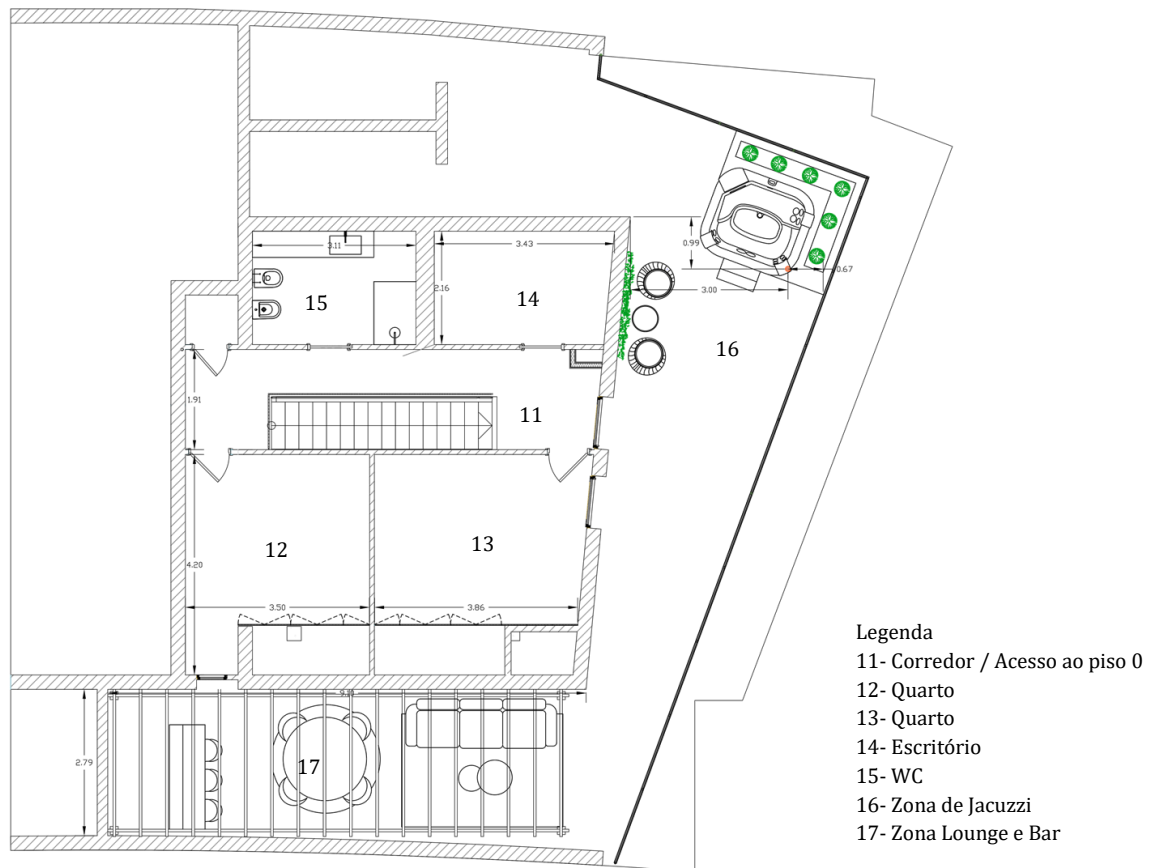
Planta Proposta | Piso 1. Fonte: autora
